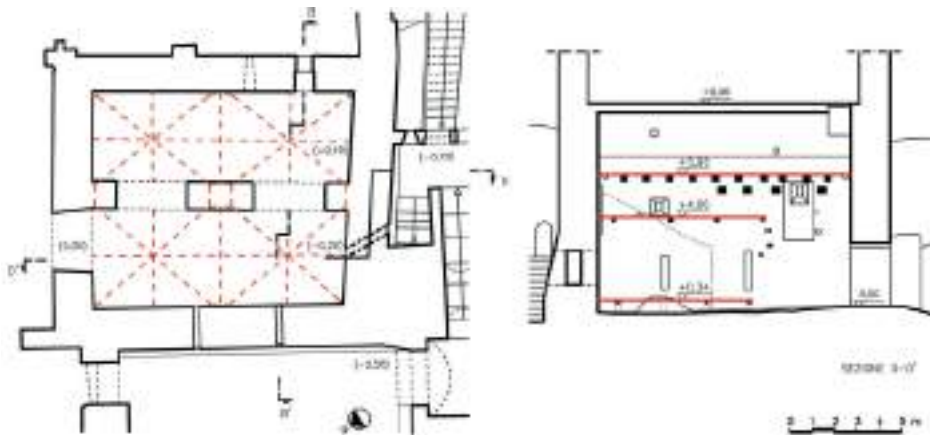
Maddaloni, rocca, *donjon*, pianta e sezione D-D'. Pianta: è indicato in rosso il probabile svolgimento delle crociere di epoca tardo-normanna. Sezione: è indicata in rosso la posizione del solaio ligneo della primitiva terrazza merlata sveva, sovrastato, a quota 9,06, dalla nuova terrazza sugli estradossi di due volte a botte. A quota 4,00 m è indicata la controsoffittatura leggera, del XIX sec., e, a quota 0,34 m, è indicato il pavimento ligneo galleggiante. Nell'angolo sud-occidentale della sala, la linea puntinata indica la traccia della scala lignea che saliva all'ammezzato (Da Fiengo - Guerriero 2012).
